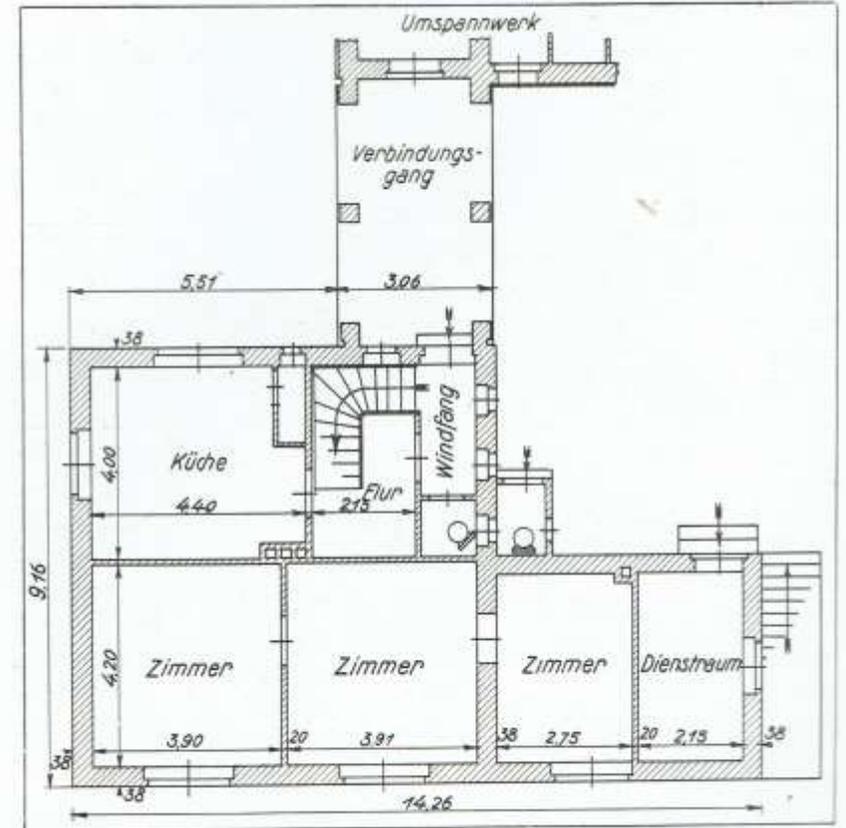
Grundriß des Beamtenwohnhauses beim Umspannwerk Weimar.
